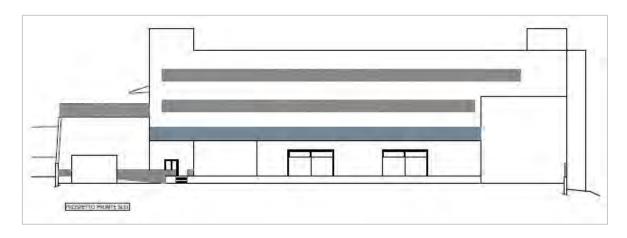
NUOVO EDIFICIO MAGAZZINO: PROSPETTO SUD
